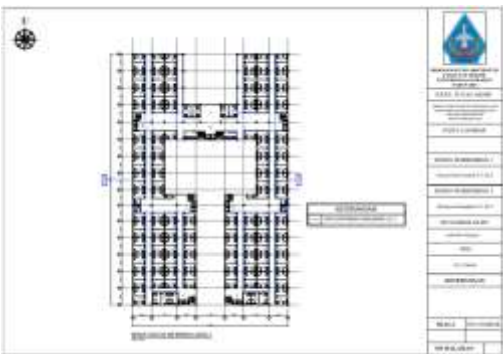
Denah Utilitas Air Bersih Lantai 4
